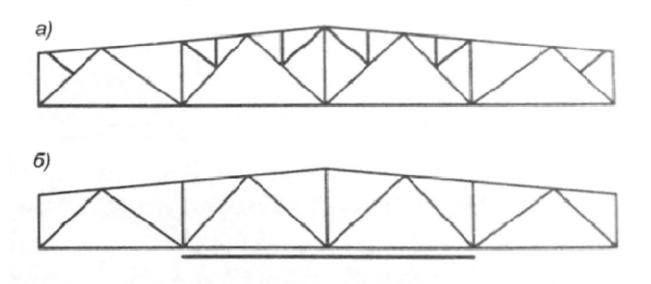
Усиление стержней стропильных ферм способом изменения конструктивной схемы: а - с помощью шпренгелей; б - с помощью преднапряженного стержня
